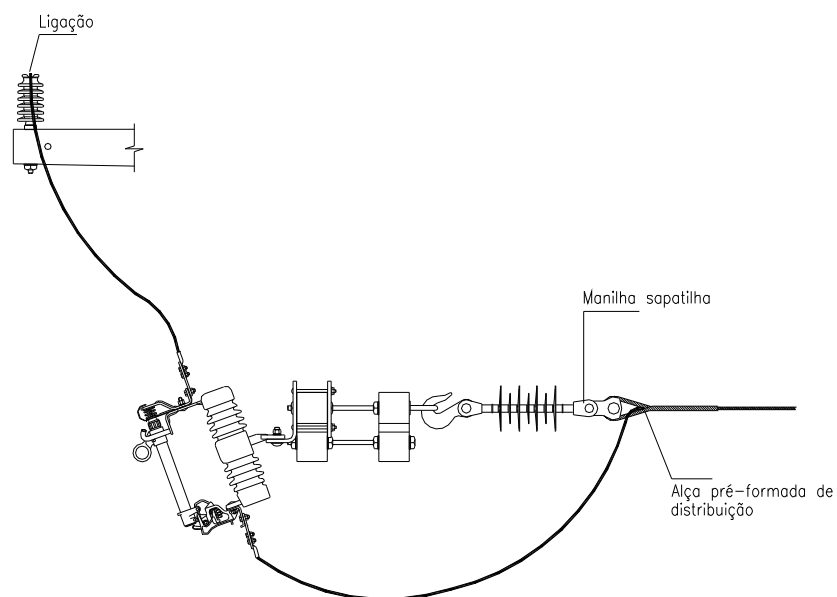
Amarrações e ligações – Primário – Chave-fusível e chave-faca em derivação
